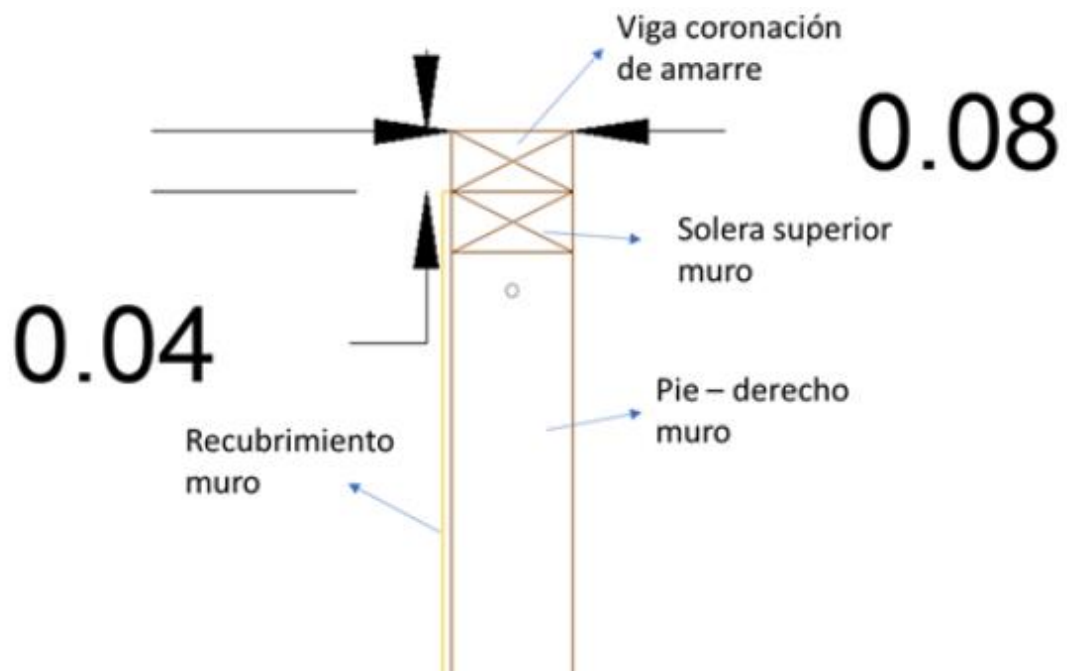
, Vista lateral muro con viga de coronación de amarre.
